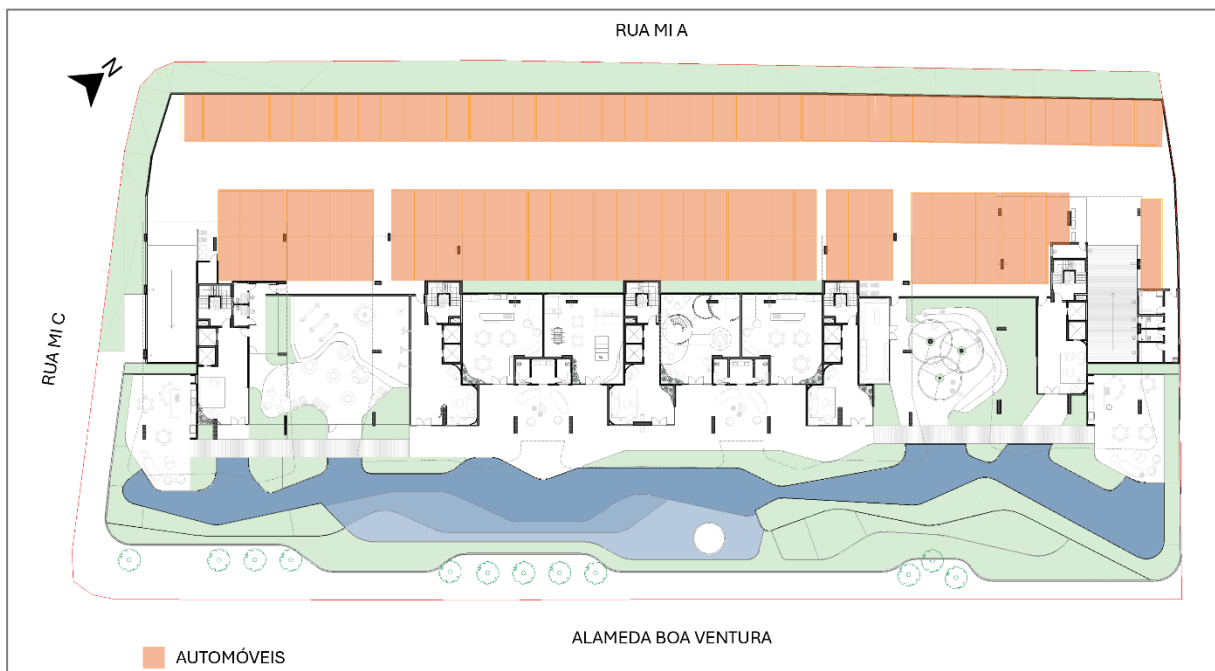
Planta esquemática do pavimento pilotis com indicação da localização e tipos de vagas.
